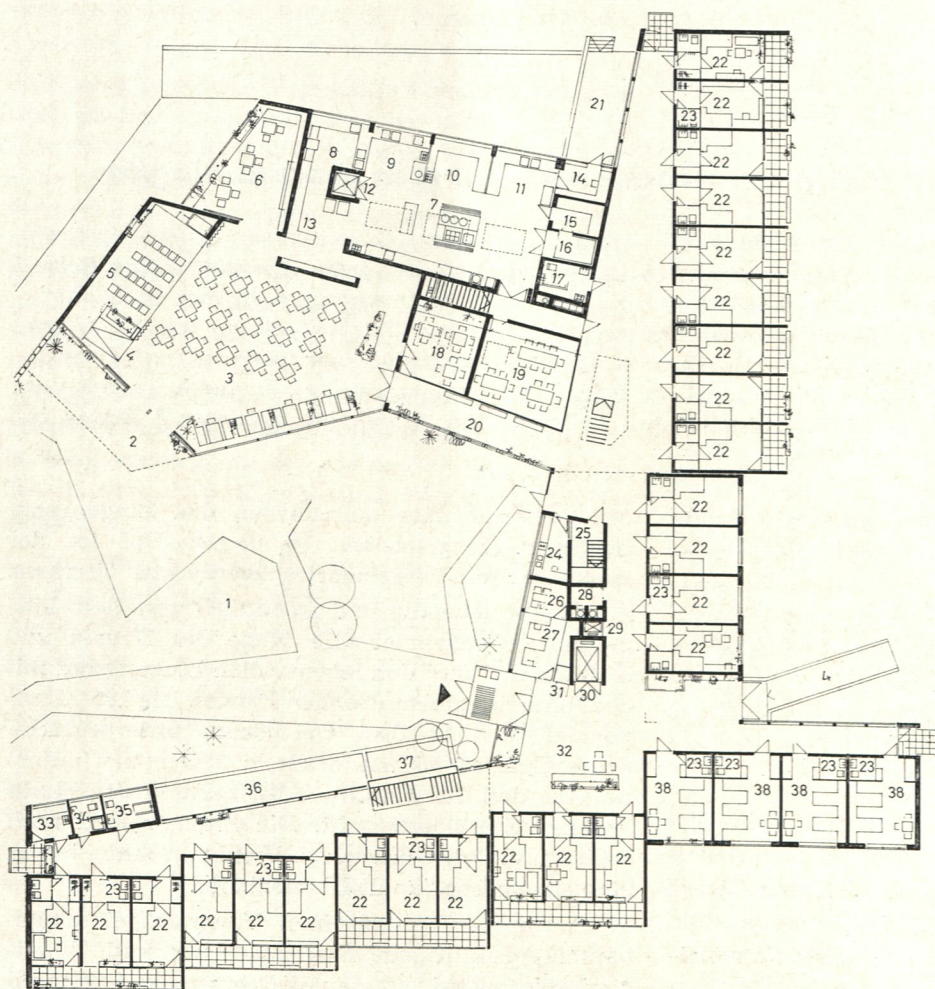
Grundriß des Erdgeschosses im Alten- und Pflegeheim. Die Ziffern bedeuten:
